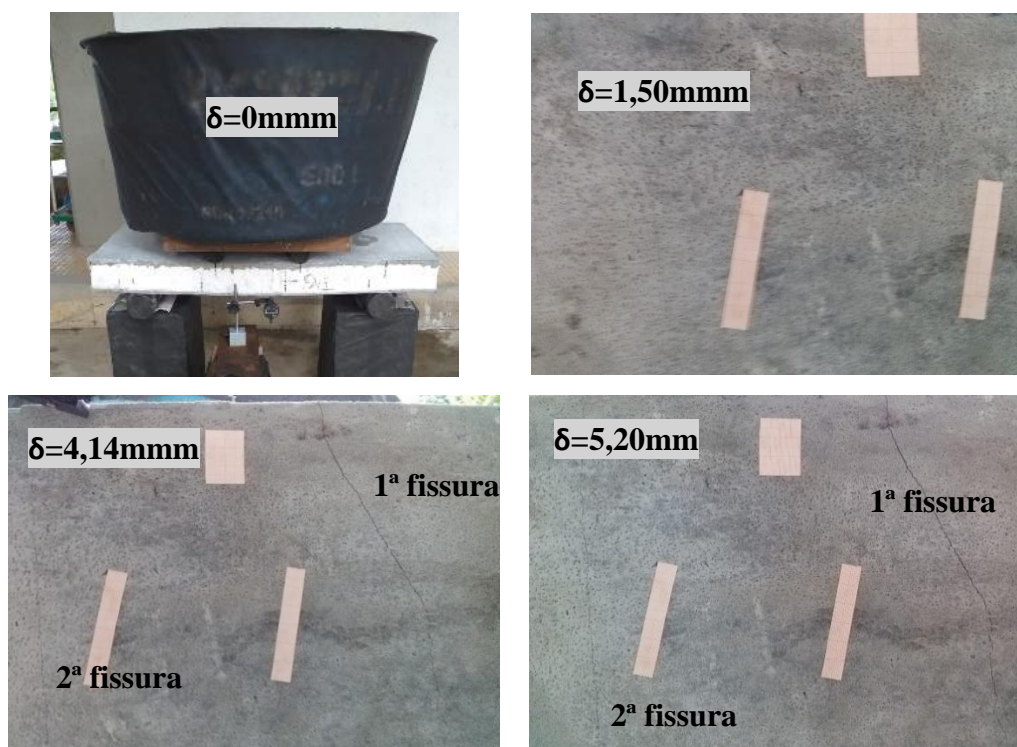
Processo de abertura de fissuras no painel sanduíche.
